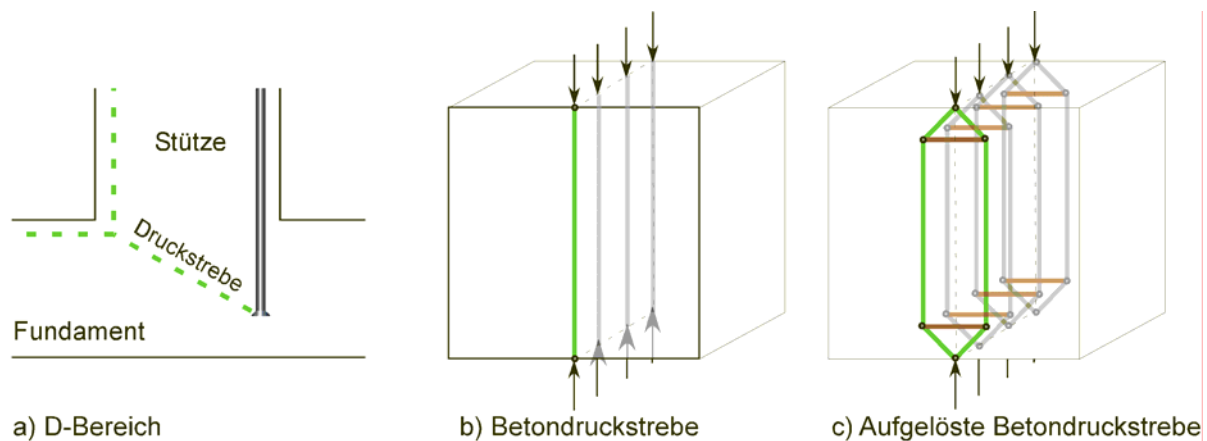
a) D-Bereich mit Druckstrebe, b) Detail einer Betondruckstrebe und c) aufgelöste Betondruckstrebe
